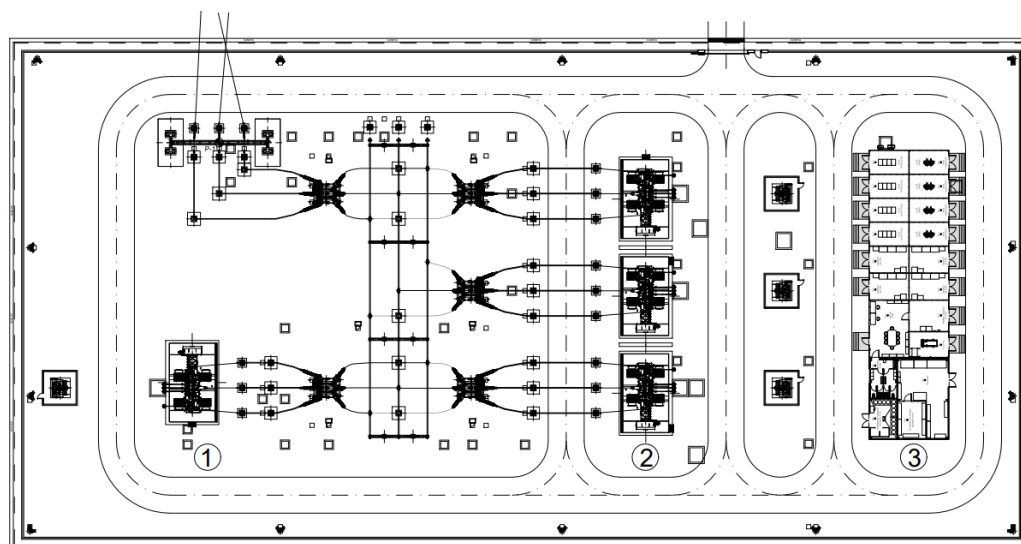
Planta general de la disposición de equipos de la SET Cortijo Nuevo 30/220 kV.
